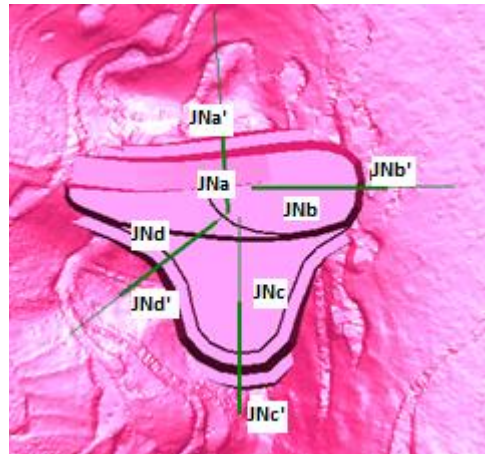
Secciones propuestas rajo Japón Norte.
